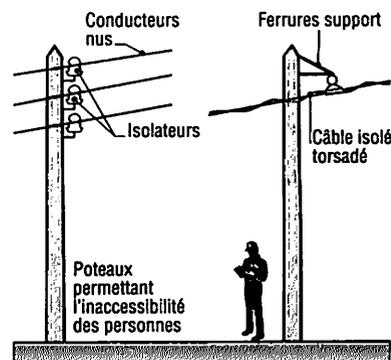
Ligne aérienne sur poteau bois ou ciment.
